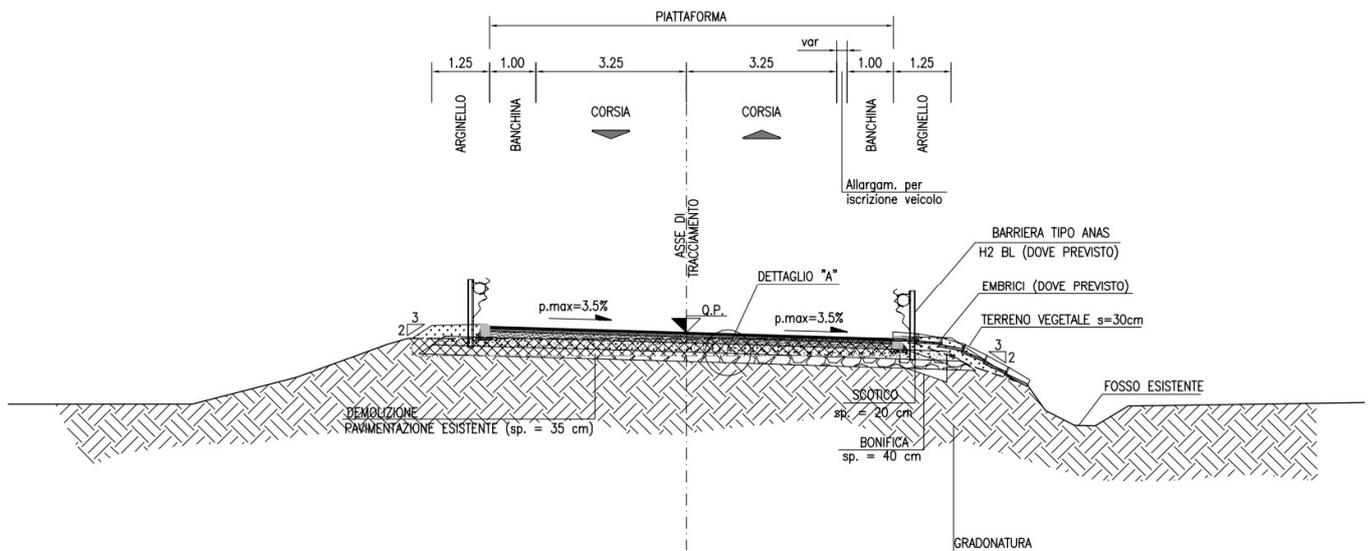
Sezione tipo RAMO 1 (SR 105)
